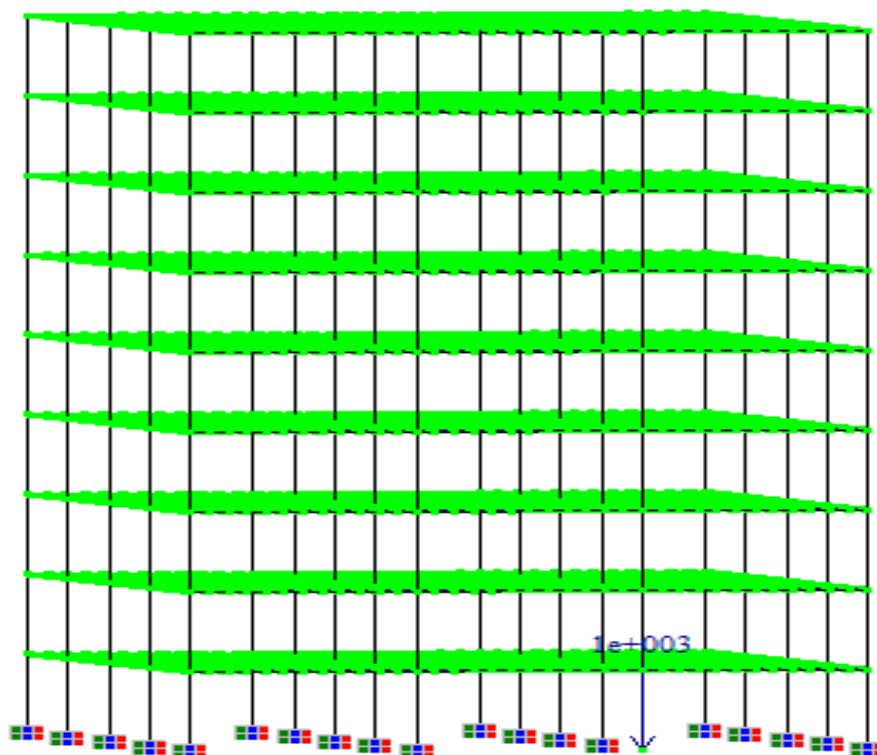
Schéma illustratif du modèle d'étude du bâtiment avec planchers sans hourdis à 9 niveaux avec un chargement vertical sur le poteau de rive
